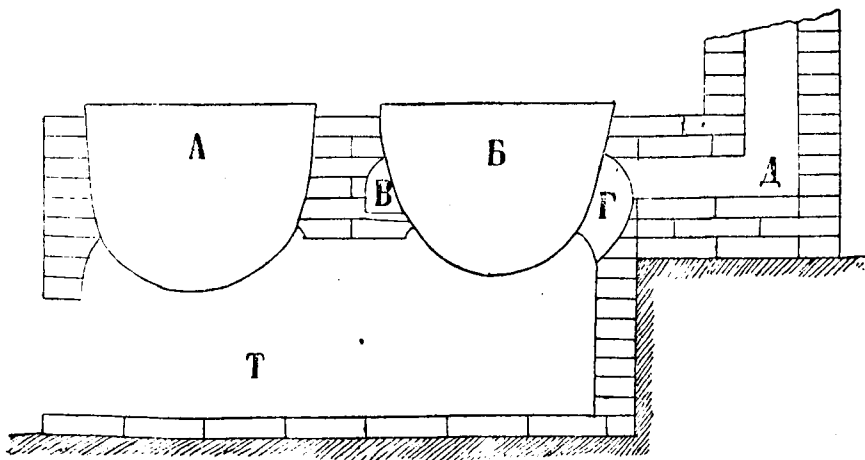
Устройство котловъ для обварки овощей (разрѣзъ по линіи К. Л.).
